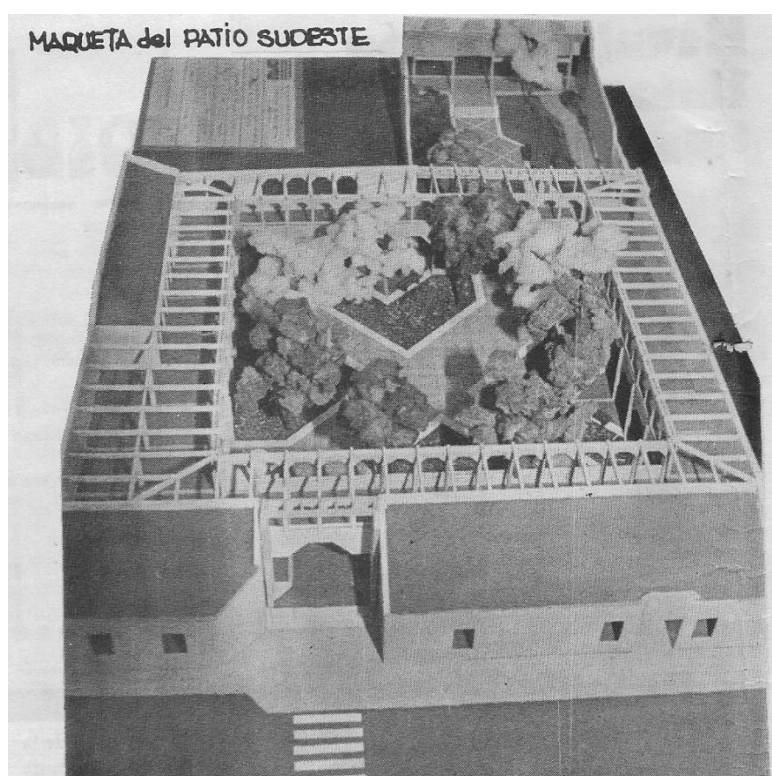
Maqueta del proyecto de la DAU. *Arquitectura y Construcción* Mayo 1983 Tucumán
